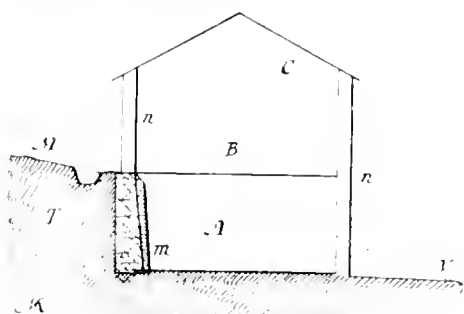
Coupe verticale d'une construction à flanc de coteau.
